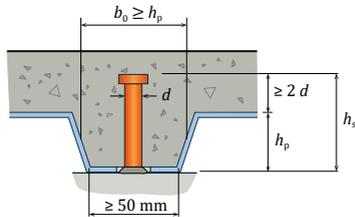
Exigences sur les dimensions d'une connexion avec bac acier perpendiculaire à l'axe de la poutre
